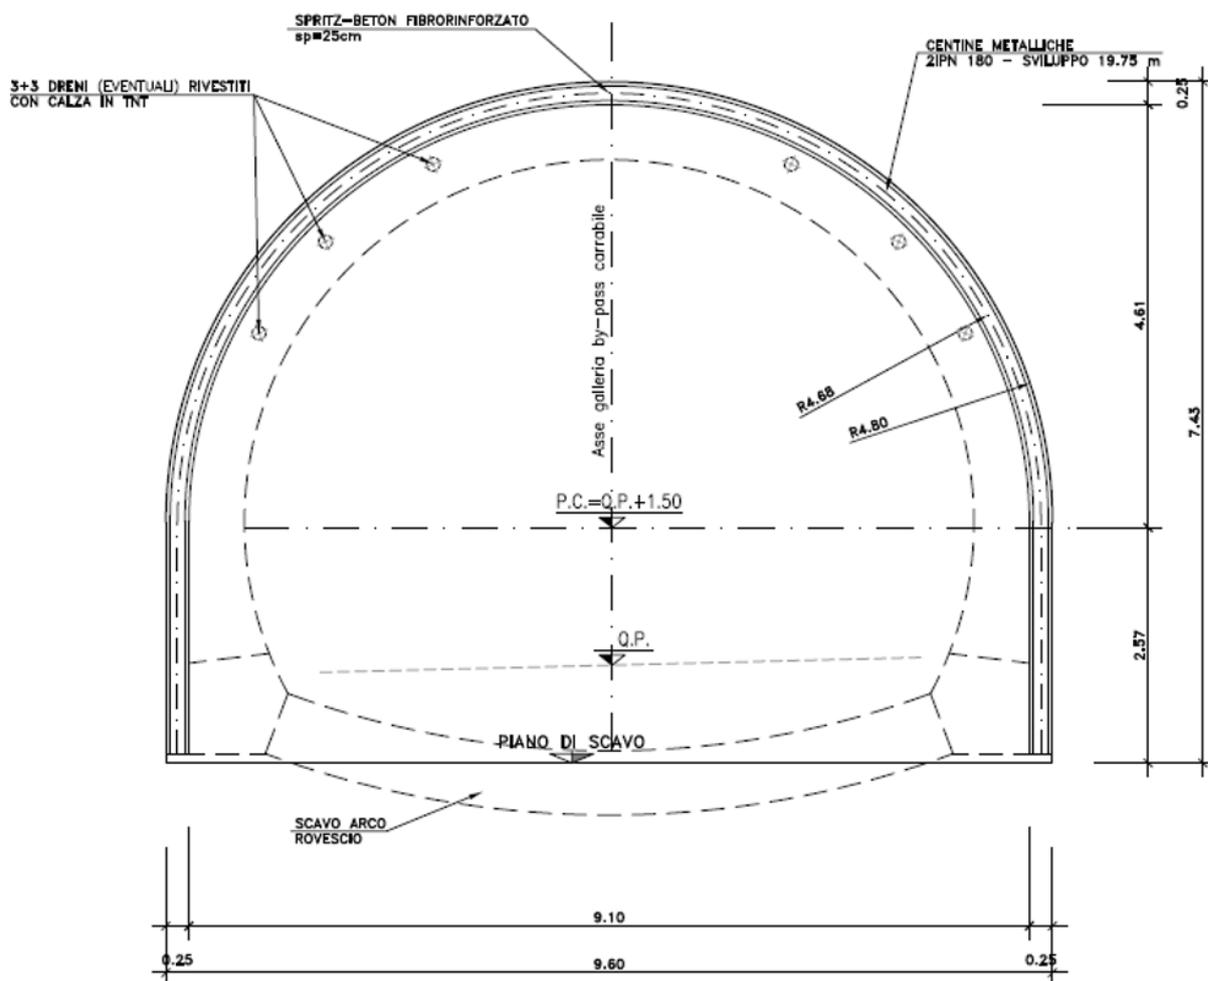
Sezione tipo di avanzamento By-Pass Carrabile
